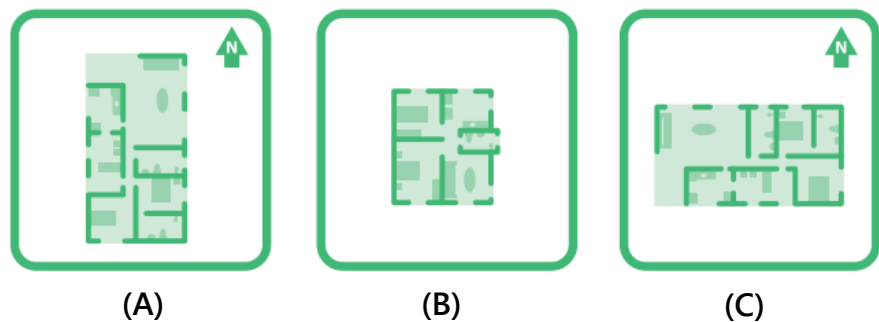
10 - Variáveis do Item 2.2 | Orientação das Fachadas do Projeto a ser Analisado. (A) Planta retangular com as maiores fachadas voltadas para Leste-Oeste; (B) Planta quadrada ou circular; (C) Planta retangular com as maiores fachadas voltadas para Norte-Sul.
